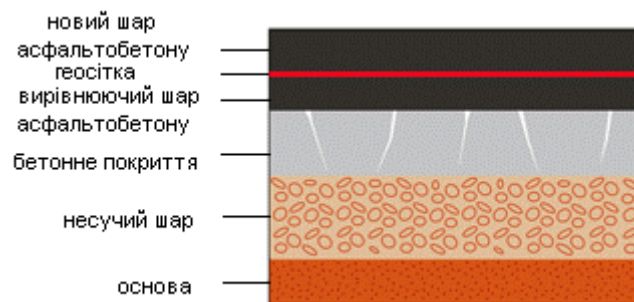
Армування асфальтобетону, покладеного на бетонне покриття
